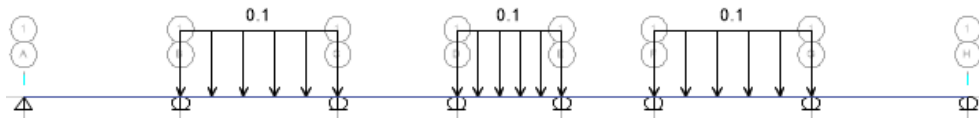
Carga viva distribuida en vigueta de losa aligerada – Damero 2
